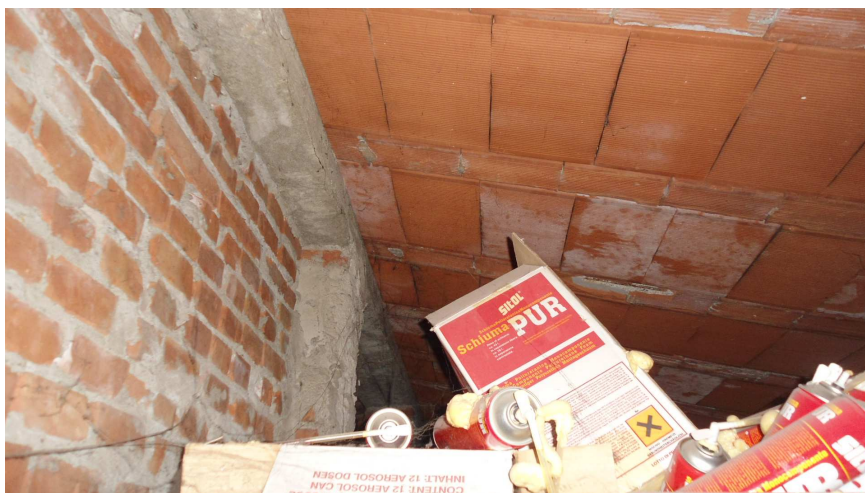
con indicato il pianerottolo e l'apertura oggetto di intervento a seguito della creazione del nuovo giunto e della muratura armata
